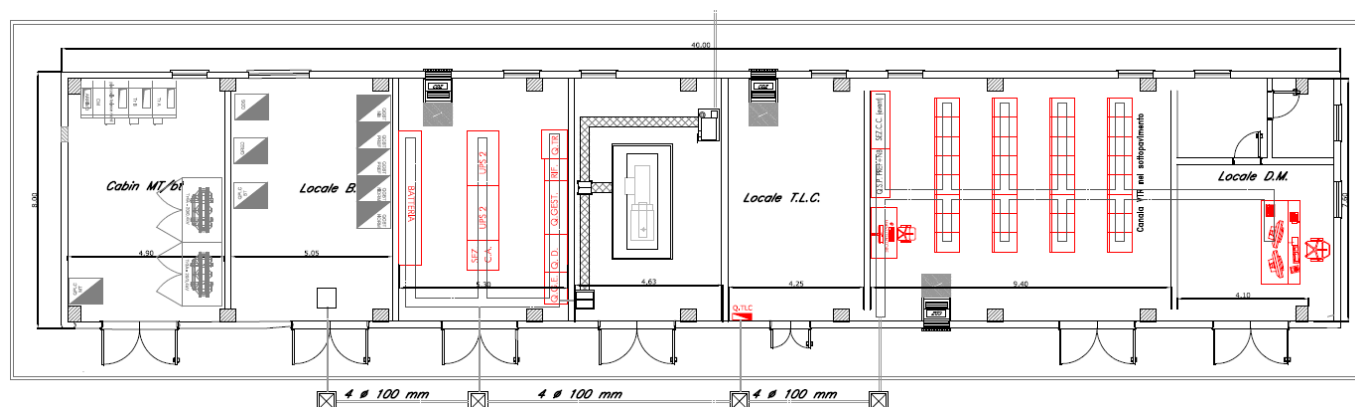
Pianta – Fabbricato tecnologico tipico (FA05, FA08)
